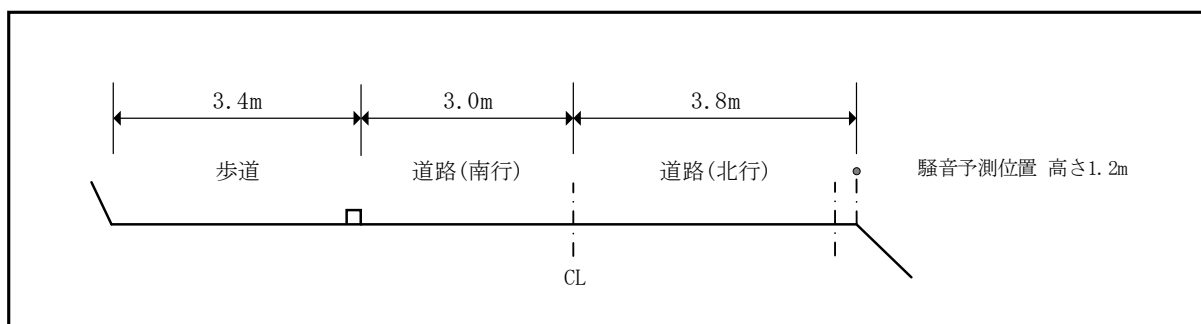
(3) 造成工事騒音予測地点断面図 (木尾町集落)
